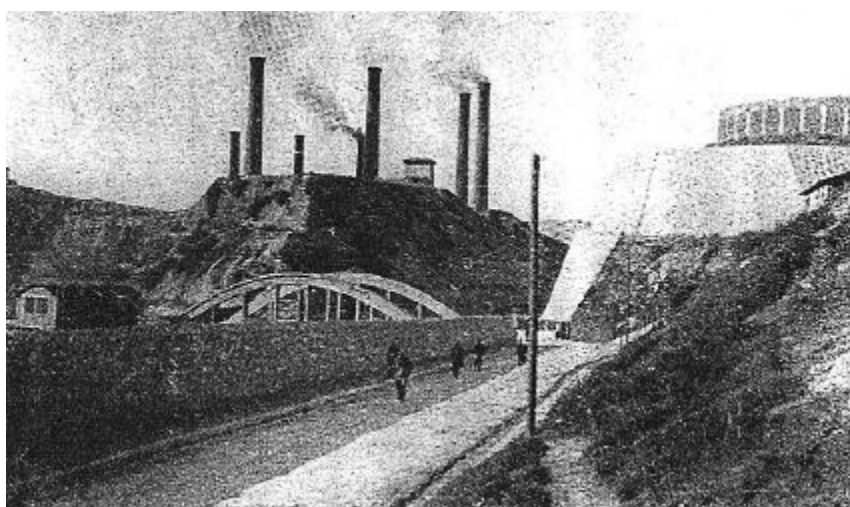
Ilustração divulgada na obra de Sigfried Giedion “*Construire em France, construire em ferre, construire em beton*” (1998).
